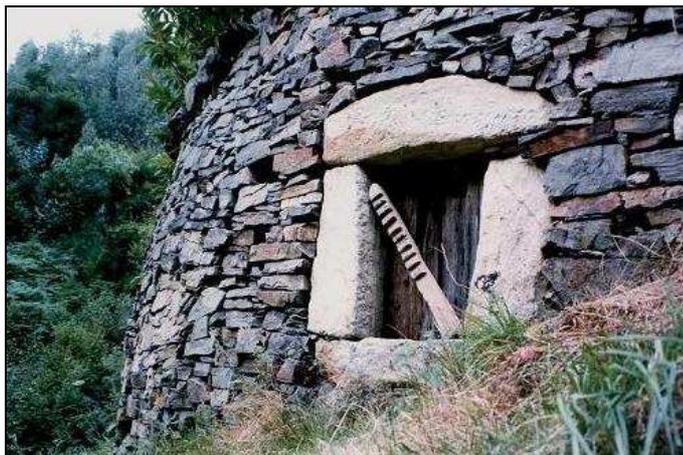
Puerta con piezas en piedra y cerrojo que se instala en el interior. Valle del Navelgas (Asturias). Fotografía: Ernesto Díaz.
